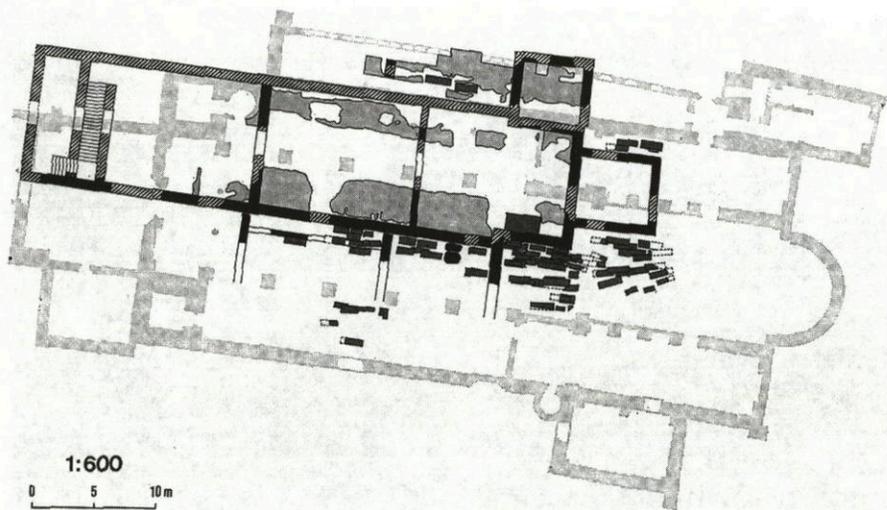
Regensburg, ehemalige Damenstiftskirche Niedermünster, Bau II, Grabungsplan mit Rekonstruktion des Grundrisses.
